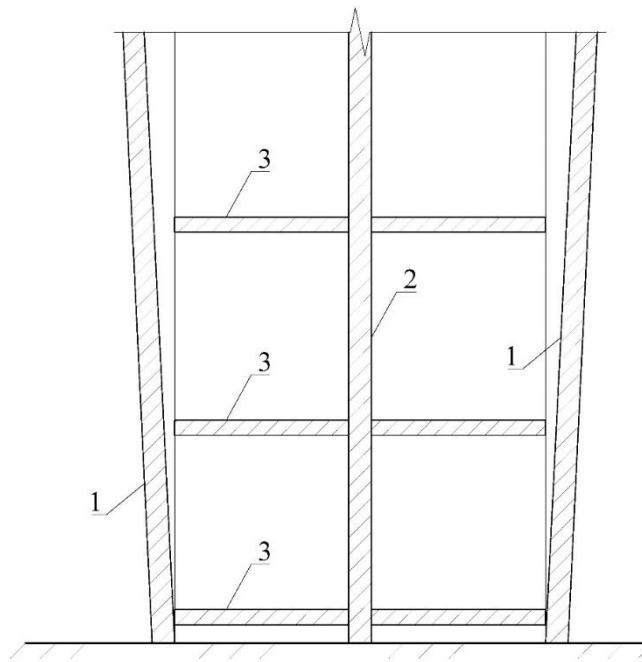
Принципиальная схема дефекта - крен стен: 1 – наружная стена, отклонившаяся от вертикали; 2 – внутренняя стена; 3 – перекрытие.
